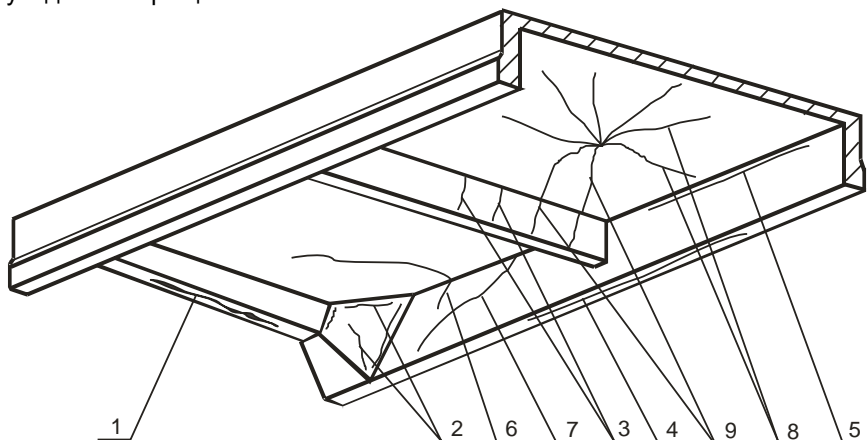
Силовые и эксплуатационные трещины ребристой плиты перекрытия (покрытия):
